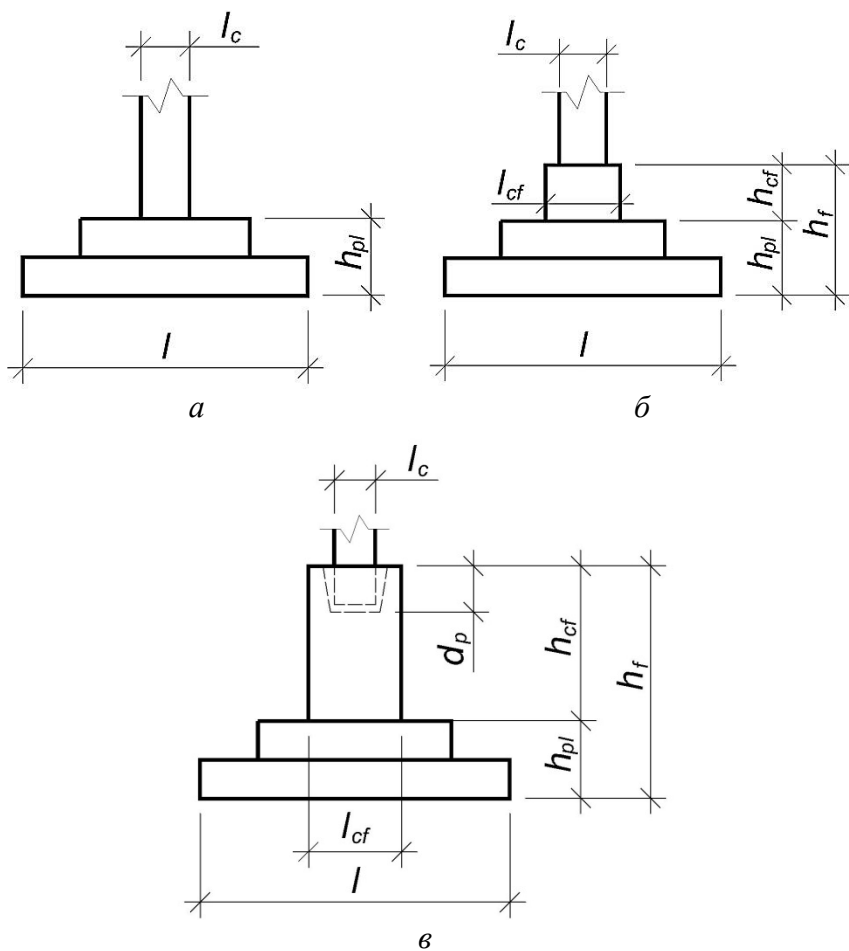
Виды сопряжений фундамента с колонной по первой схеме расчета на продавливание:
